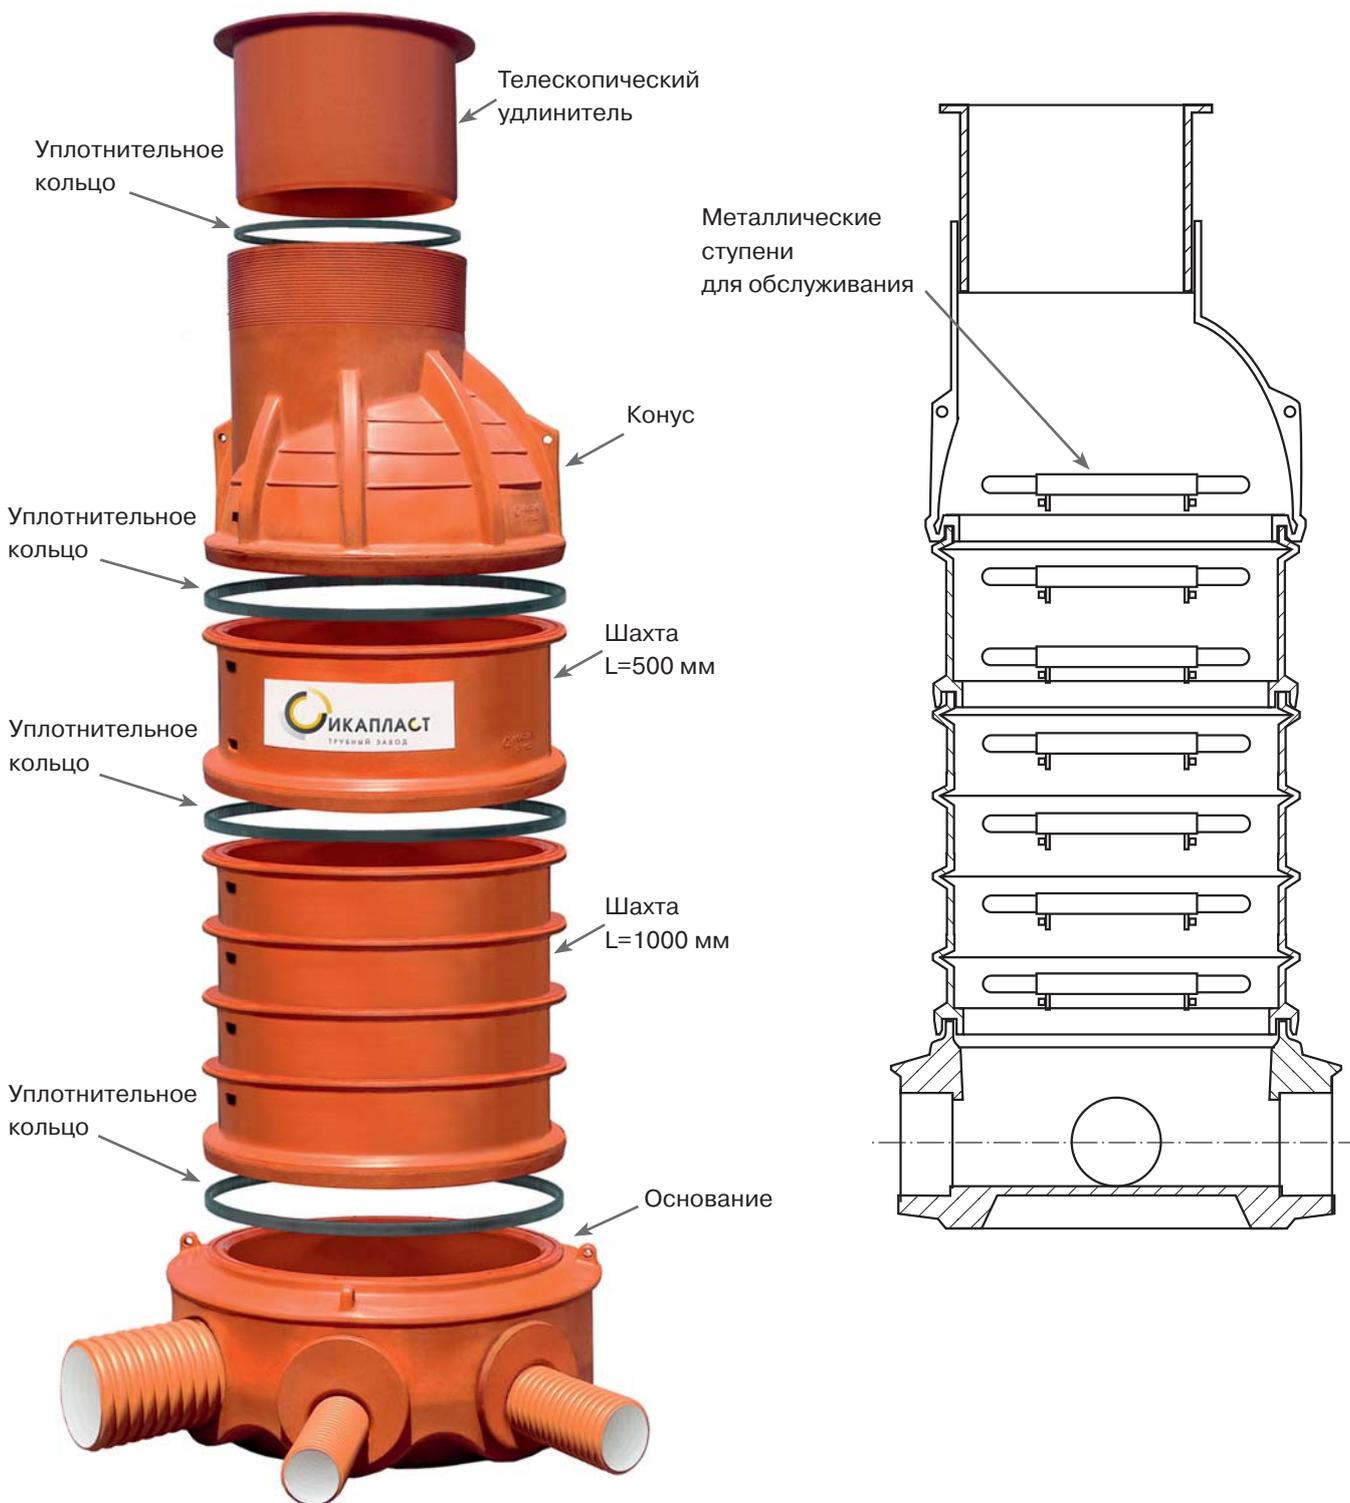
Сборный полимерный колодец ИКАПЛАСТ
